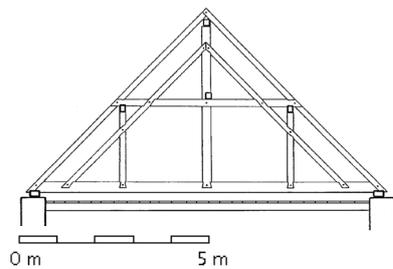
Das Sparrendach mit quer eingebundenen Sparrenpaaren wird durch drei Kehlbalkenlagen in drei Dachgeschosse und einen Spitzboden unterteilt.
